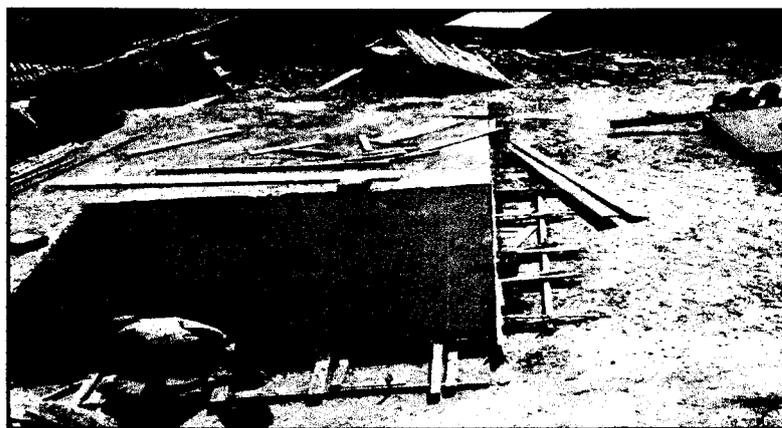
Patio de maniobras: construcción de losa vehicular..
